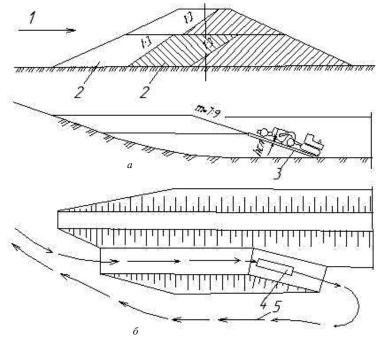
Деление сооружения на ярусы и призмы укладки грунта при возведении насыпного сооружения в зимнее время: a – разбивка на ярусы и призмы укладки грунта в насыпь; δ – укладка грунта наклонными слоями; I – верхний бьеф; 2 – призмы укладки; 3 – наклонная площадка; 4 – выгрузка грунта скрепером; 5 – путь движения скреперов в карьер
